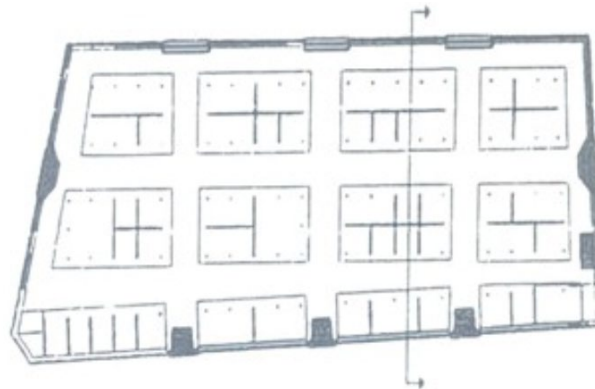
Plano de la planta baja del mercado de San Miguel. Fuente: http://oa.upm.es/39203/7/TFG_SERGIO_LUQUE_LOPEZ.pdf
